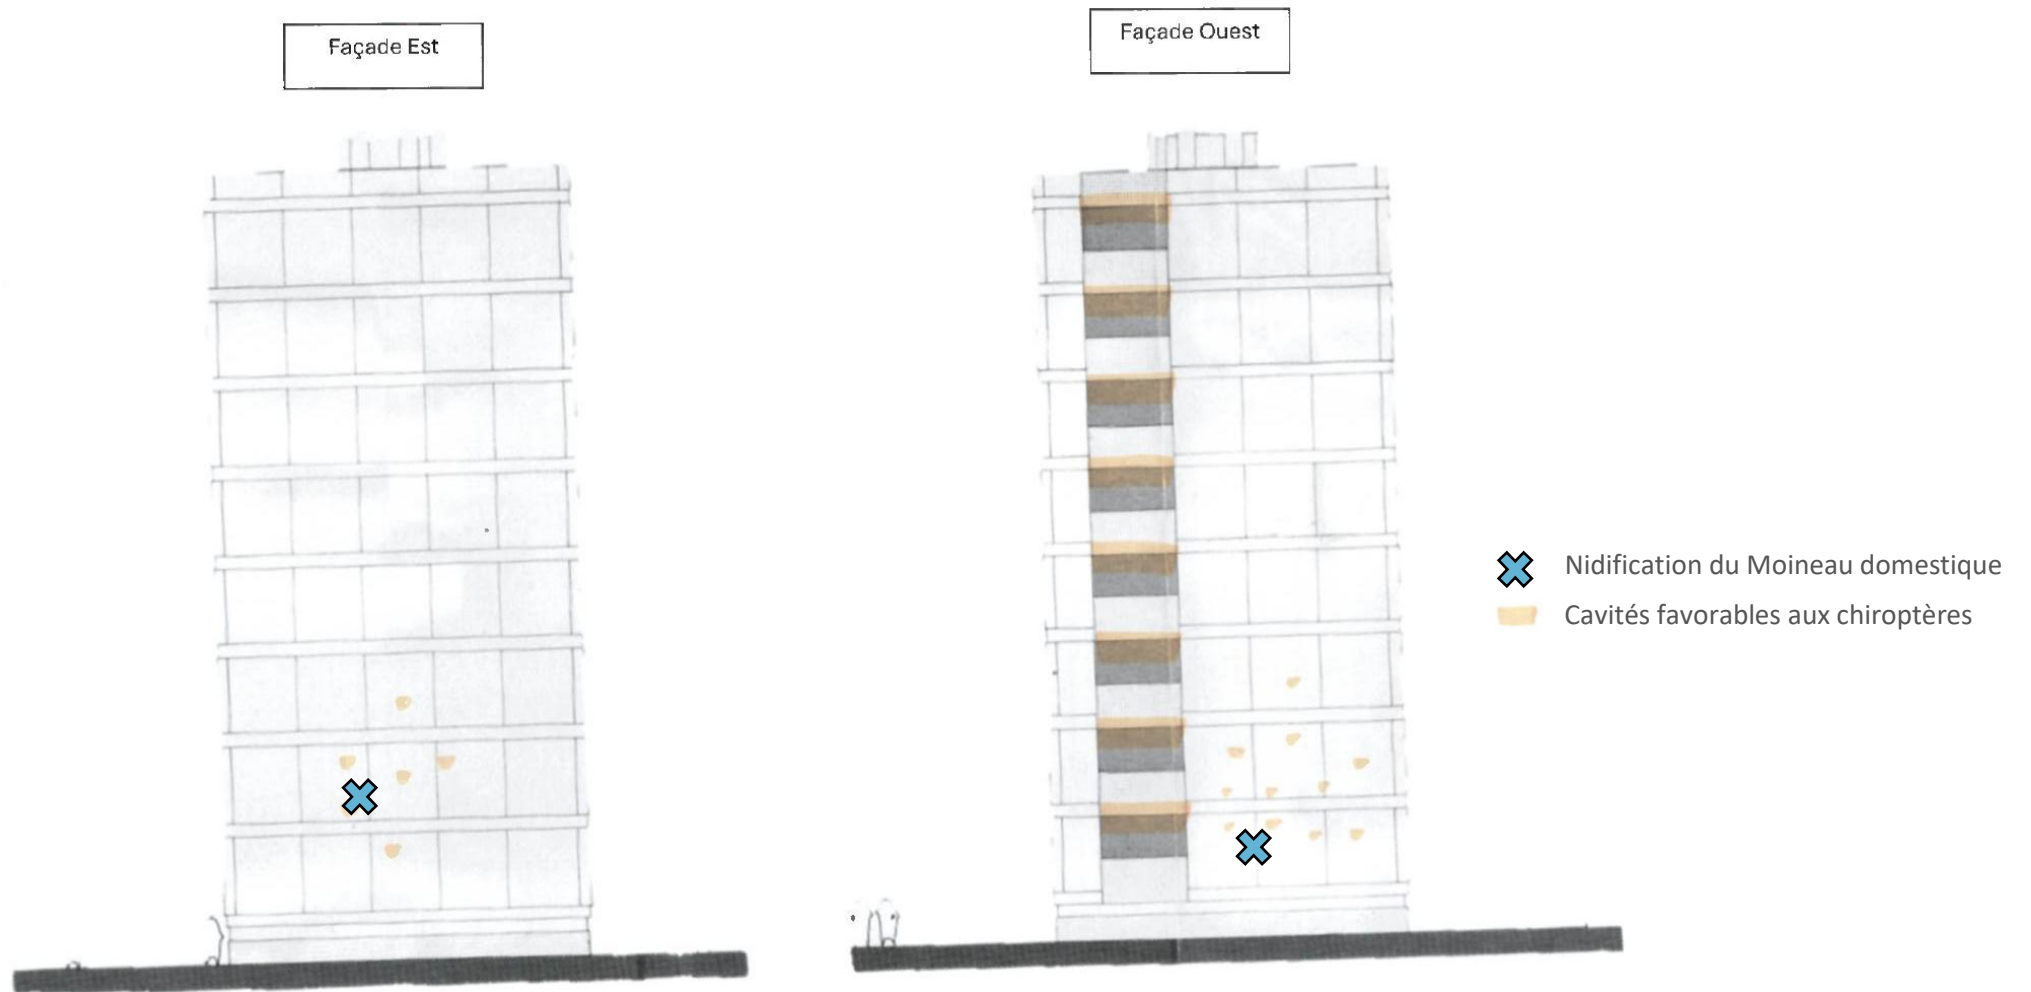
Plan du bâtiment 22 (façades est et ouest) des cavités favorables aux chiroptères et des Moineaux domestiques
